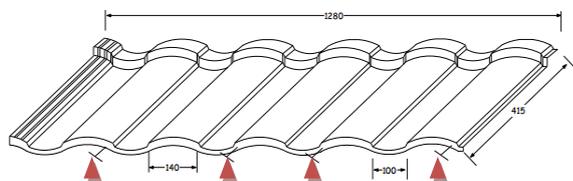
tuile METROTILE® SHAKE - pose des fixations
